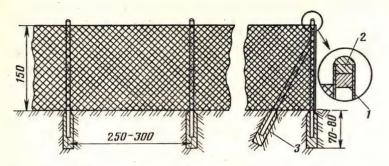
Устройство сетчатого забора на трубчатых столбах: 1—деревянная пробка; 2—бетон; 3—дополнительное крепление столбов угловых и для ворот.
